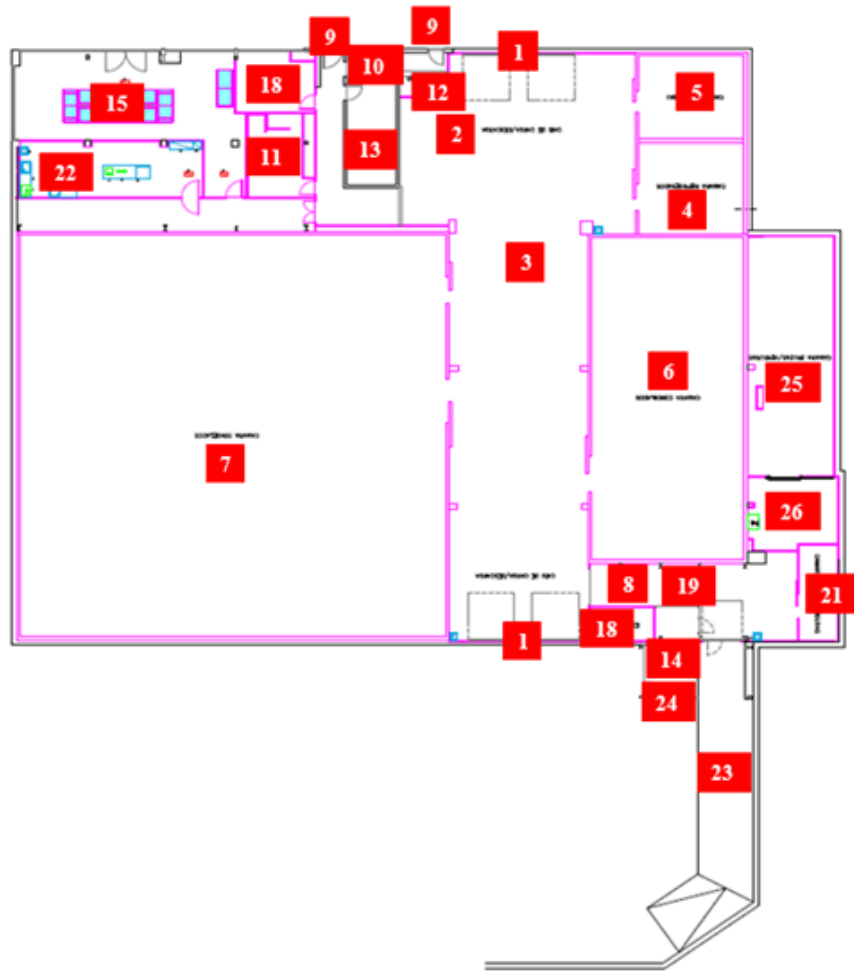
Planta das instalações da Gelcentro (Gelcentro, 2019).
